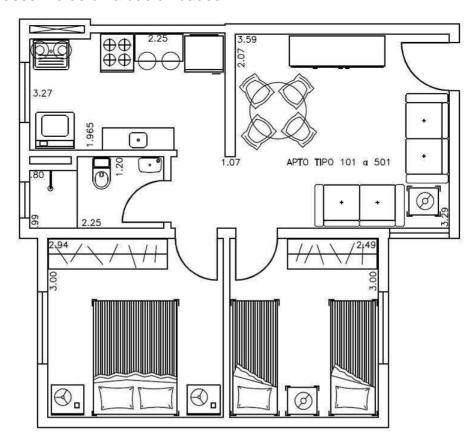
Planta baixa humanizada do apartamento tipo (sem escala).
